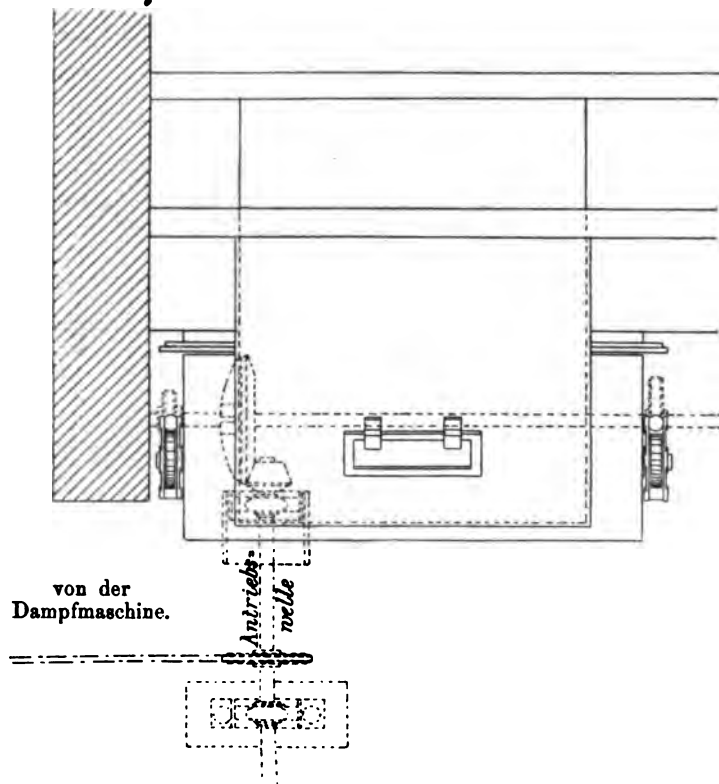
Grundriss der mechanischen Stocher.
